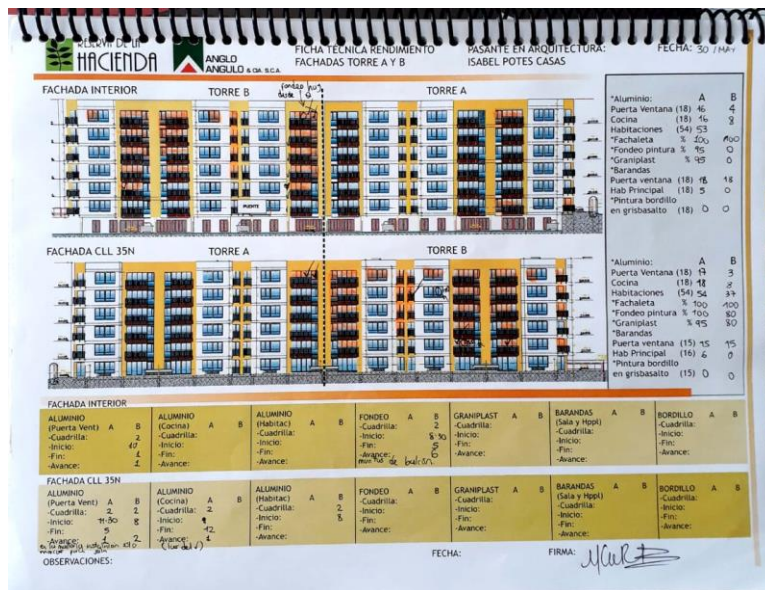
Ejemplo 2 implementación de ficha rendimiento de fachadas
